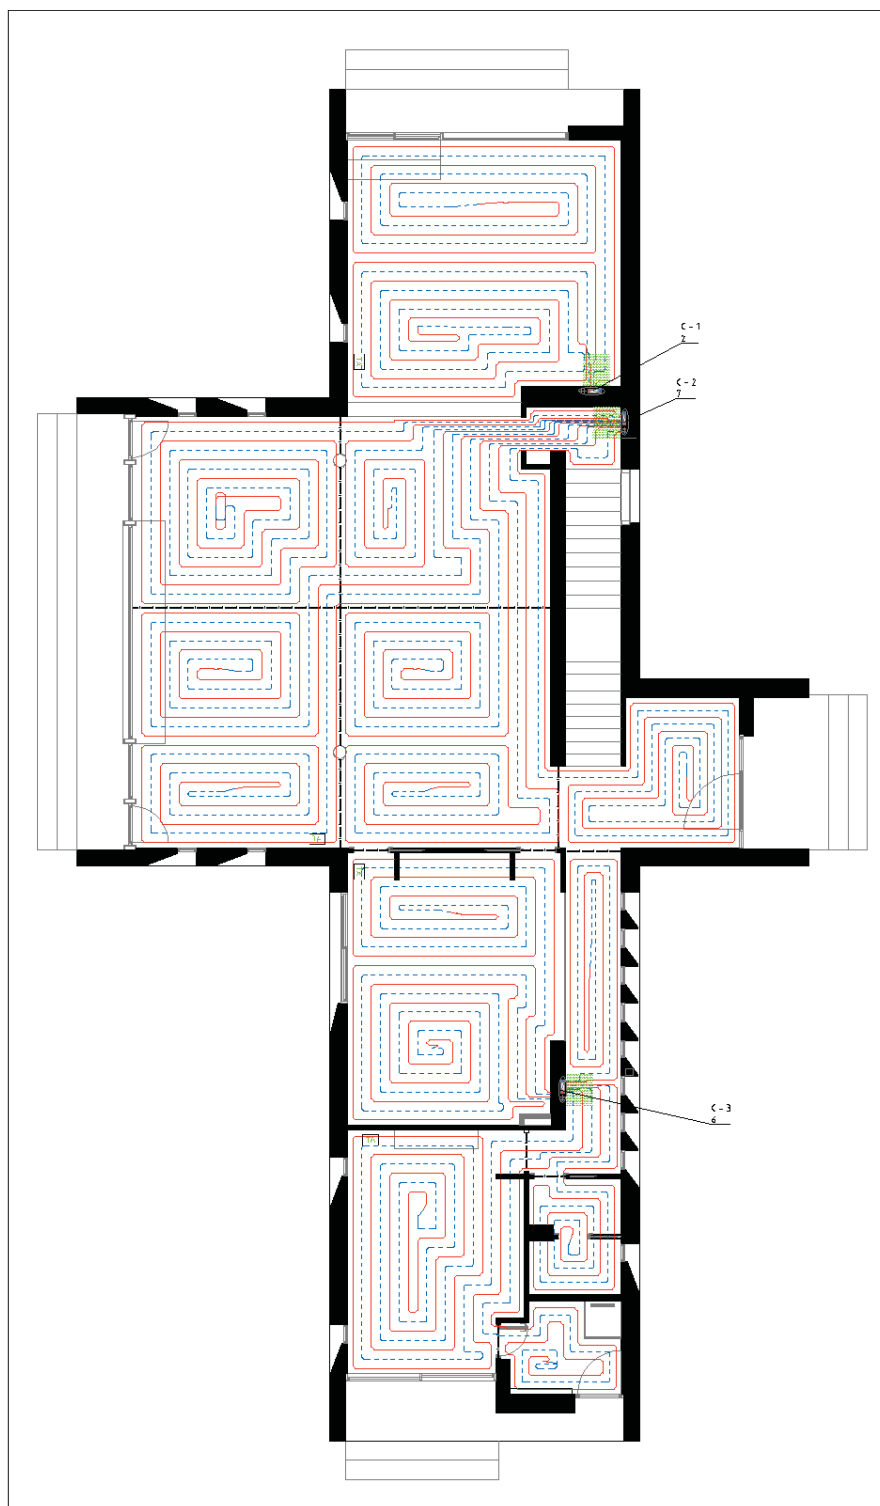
Schema di posa pannello radiante a pavimento piano terra
